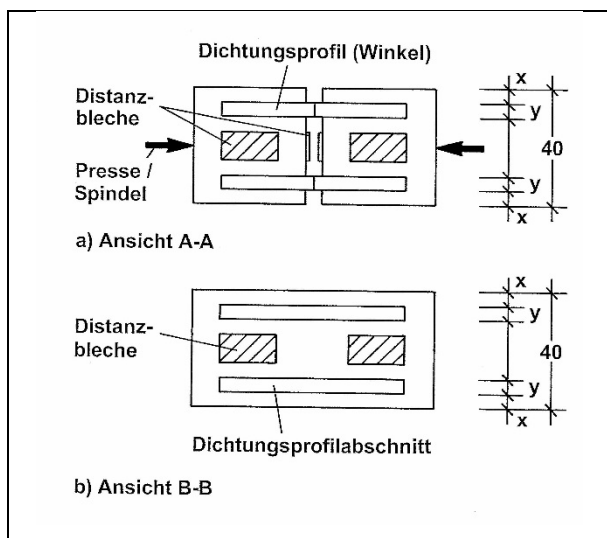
Betonprüfkörper für den Abplatzversuch (Grundriss)
